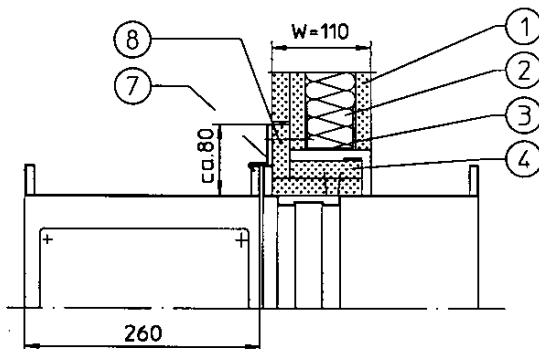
Einbausituation in zweiseitig beplankte Schachtwand
